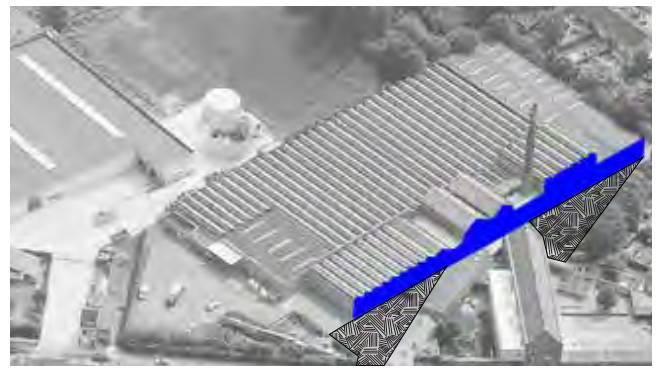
illustratie van de ruggengraat met afwerking naar Walle toe en weergave van 2 driehoekige pleinen op de BIC-site
